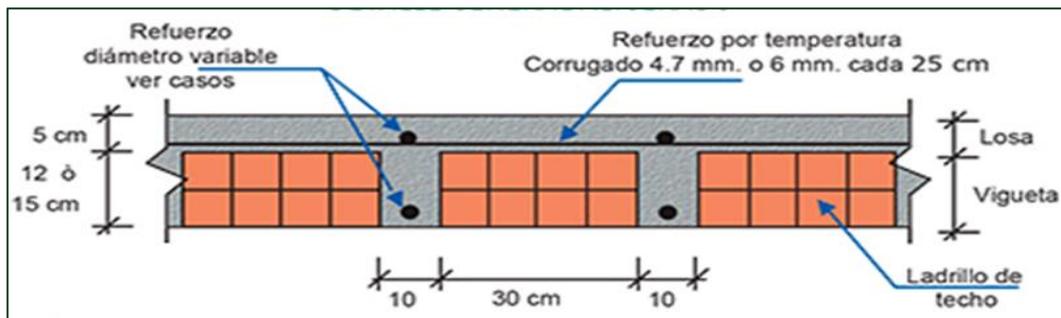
DETALLE GENERAL DE LOSA ALIGERADA
